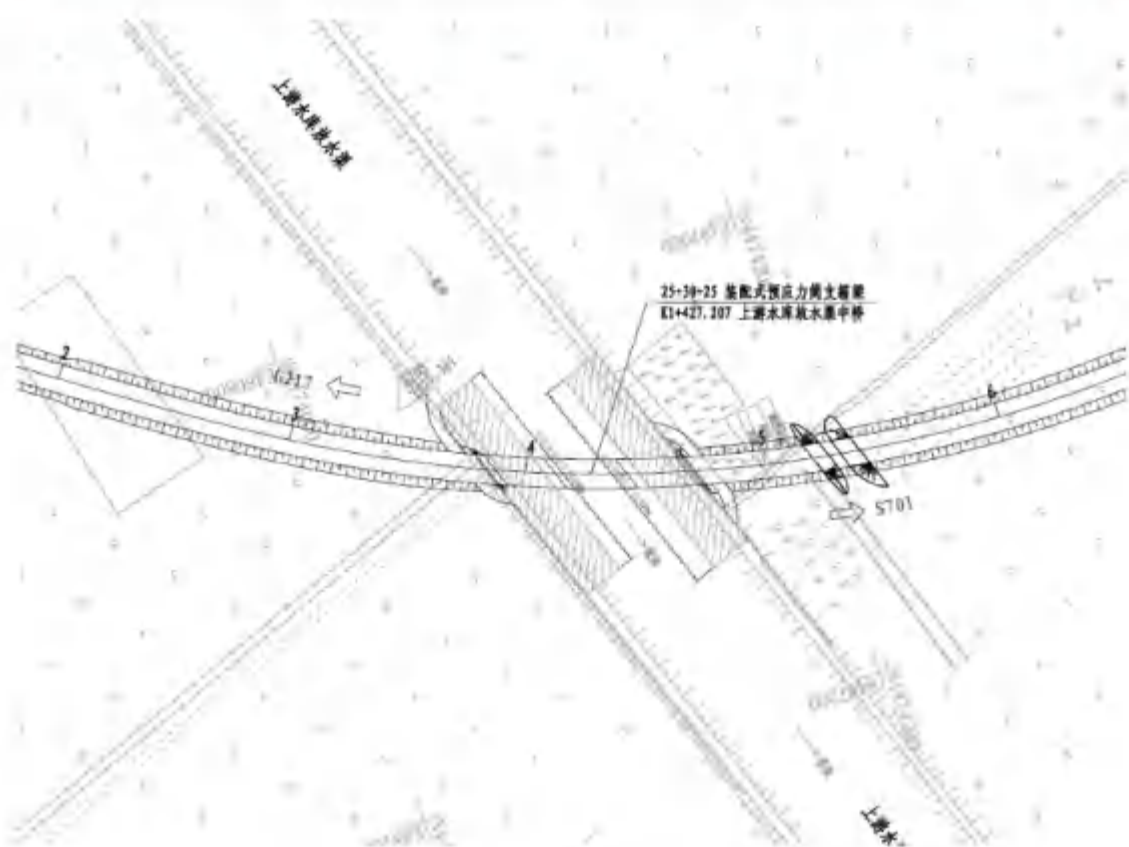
上游水库放水渠中桥桥位平面布置图
